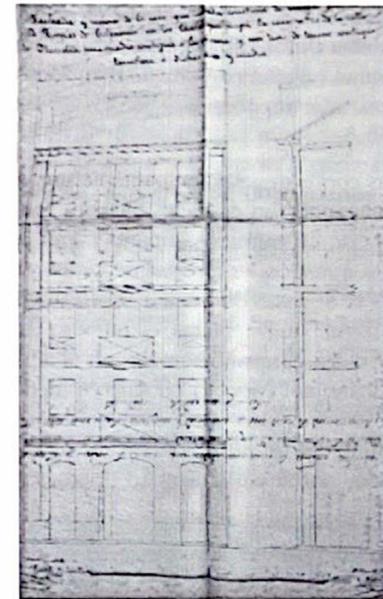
Plano original de la casa número 21, hoy 17 de la calle Iturrubide.
